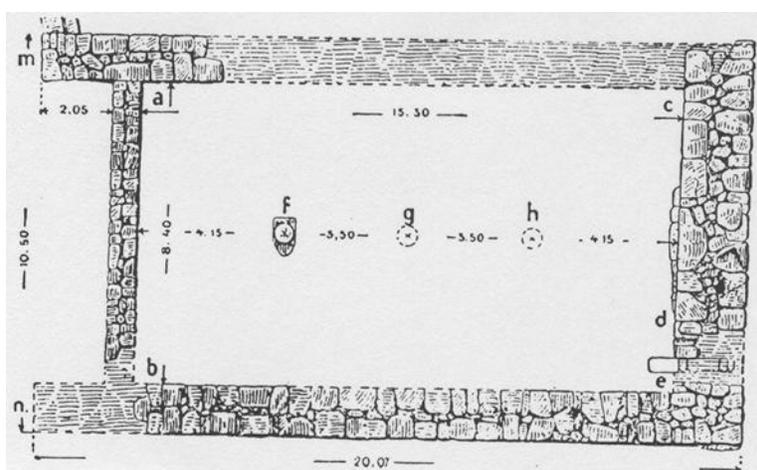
Construção C em Tróia VI. Os elementos centrais são bases em pedra para colunas em madeira, com a finalidade de dar suporte ao pesado telhado de barro e madeira.
